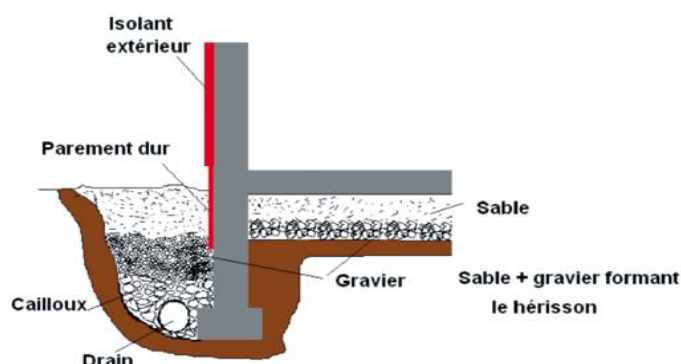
Isolation des planchers bas sur terre-plein (GIZ)
